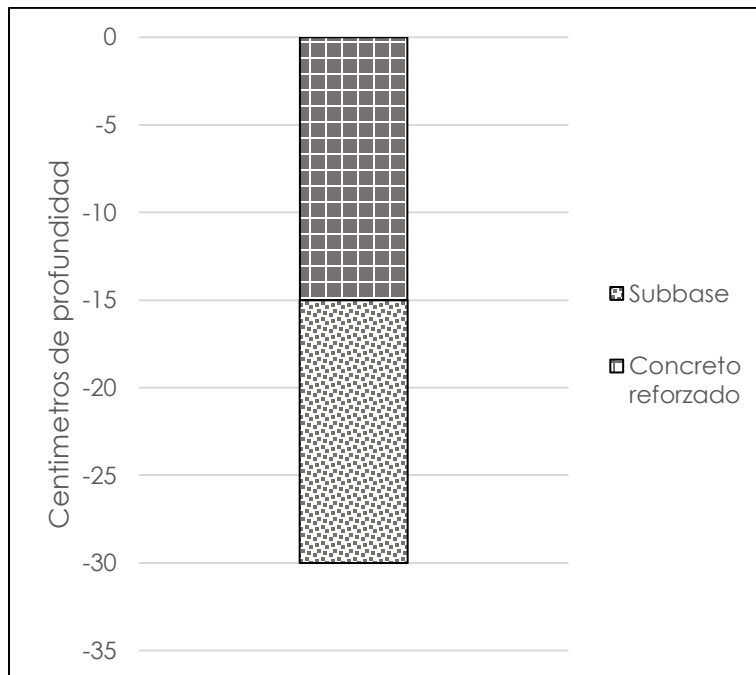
Corte de la estructura de pavimento para el proyecto de Rionegro-Santander
